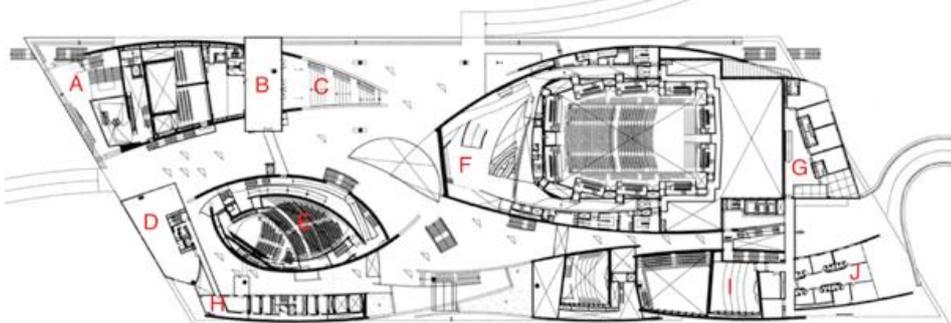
Planta baixa Cidade das Artes - Usos e fluxos
